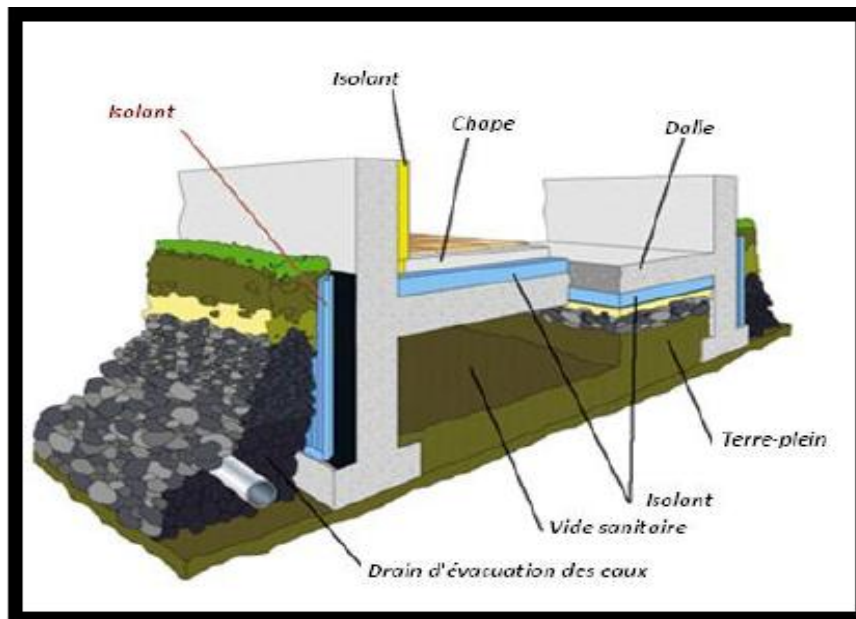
ITE murs et plancher sur vide sanitaire. [11]
